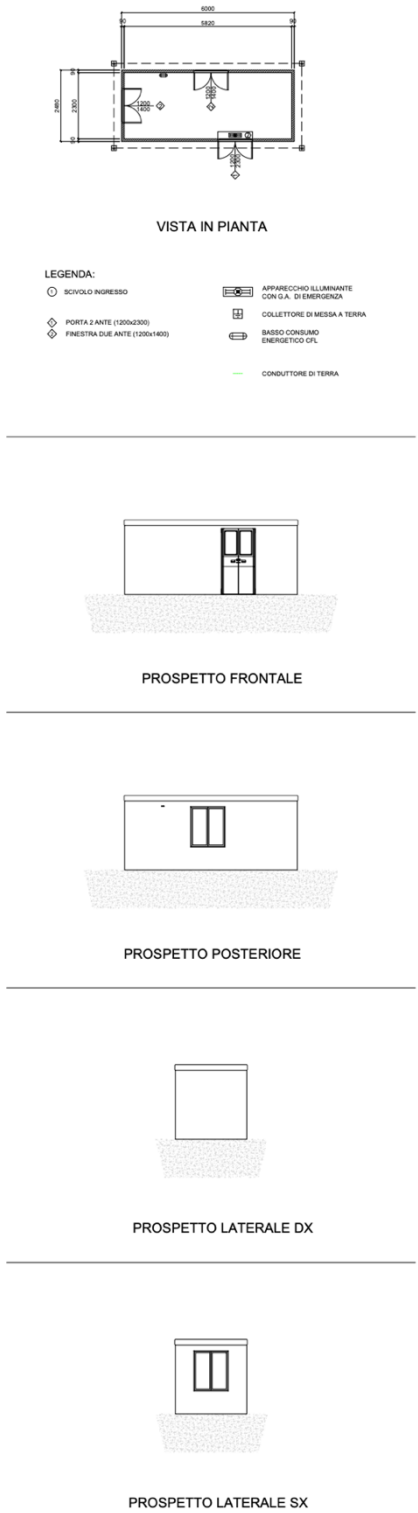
Viste planimetriche e in prospettiva del locale controllo e monitoraggio
